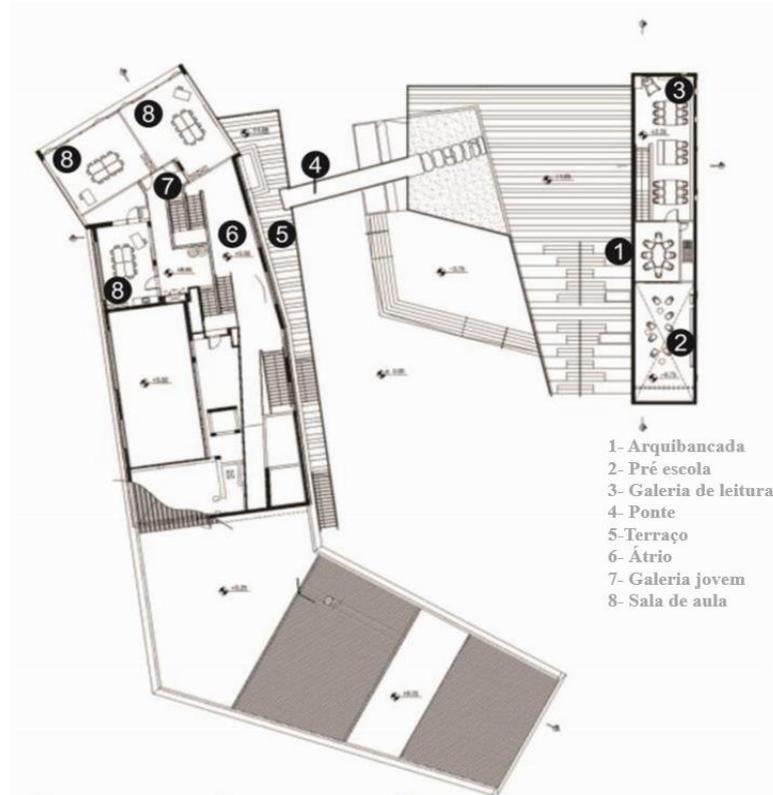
Centro Comunitário Rehovot (a) planta layout térreo
